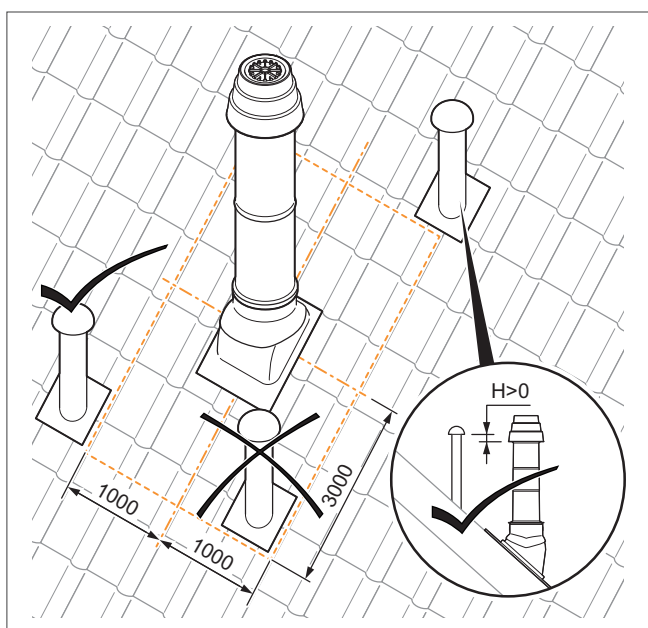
Mindestabstände bei Dachdurchführung (Angaben in mm)
